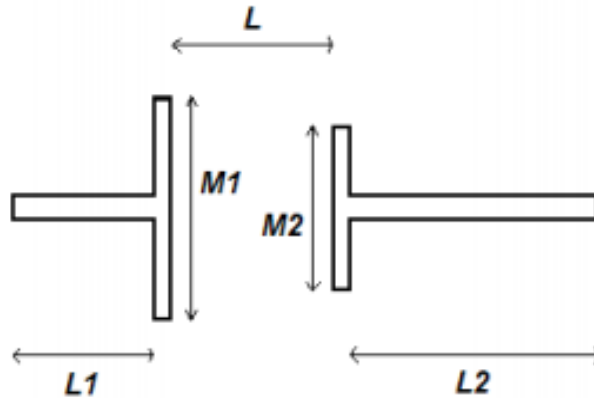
Esquema muro-losa para el cálculo del ancho efectivo según Tapia (2008).
